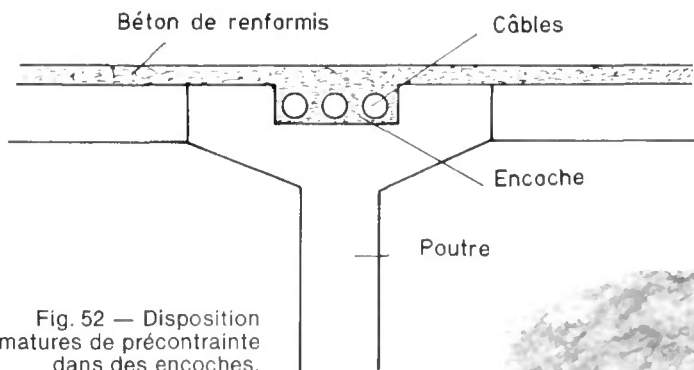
Disposition d'armatures de précontrainte dans des encoches.
